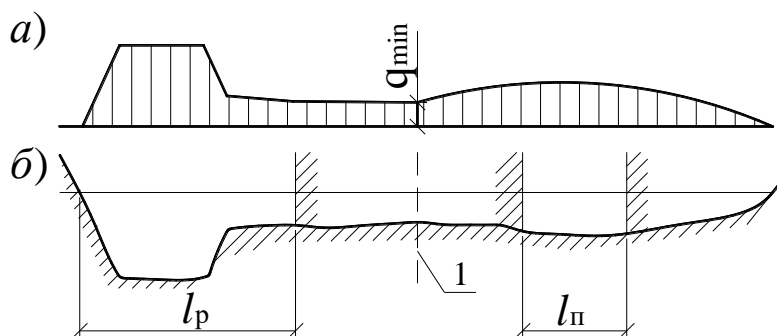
Схема к определению расчетных расходов для руслового и пойменных мостов: 1 – граница руслового и пойменного потоков; а) эпюра элементарных расходов; б) поперечное сечение реки
